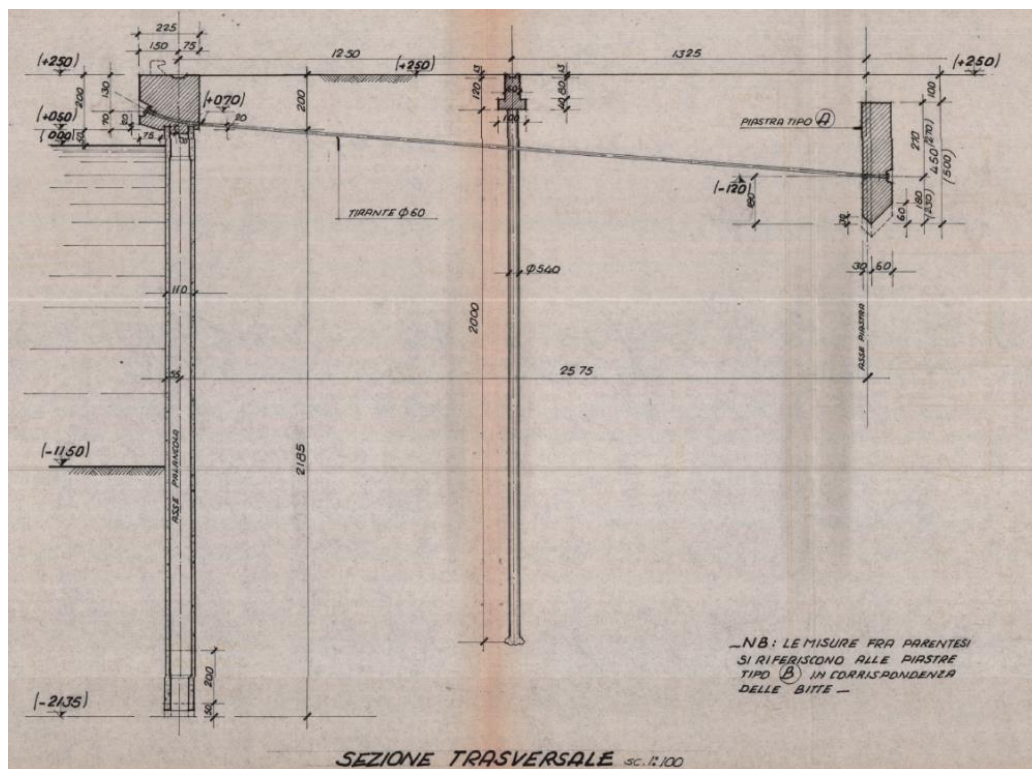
Sezione tipo del banchinamento (dal progetto del 1977)
